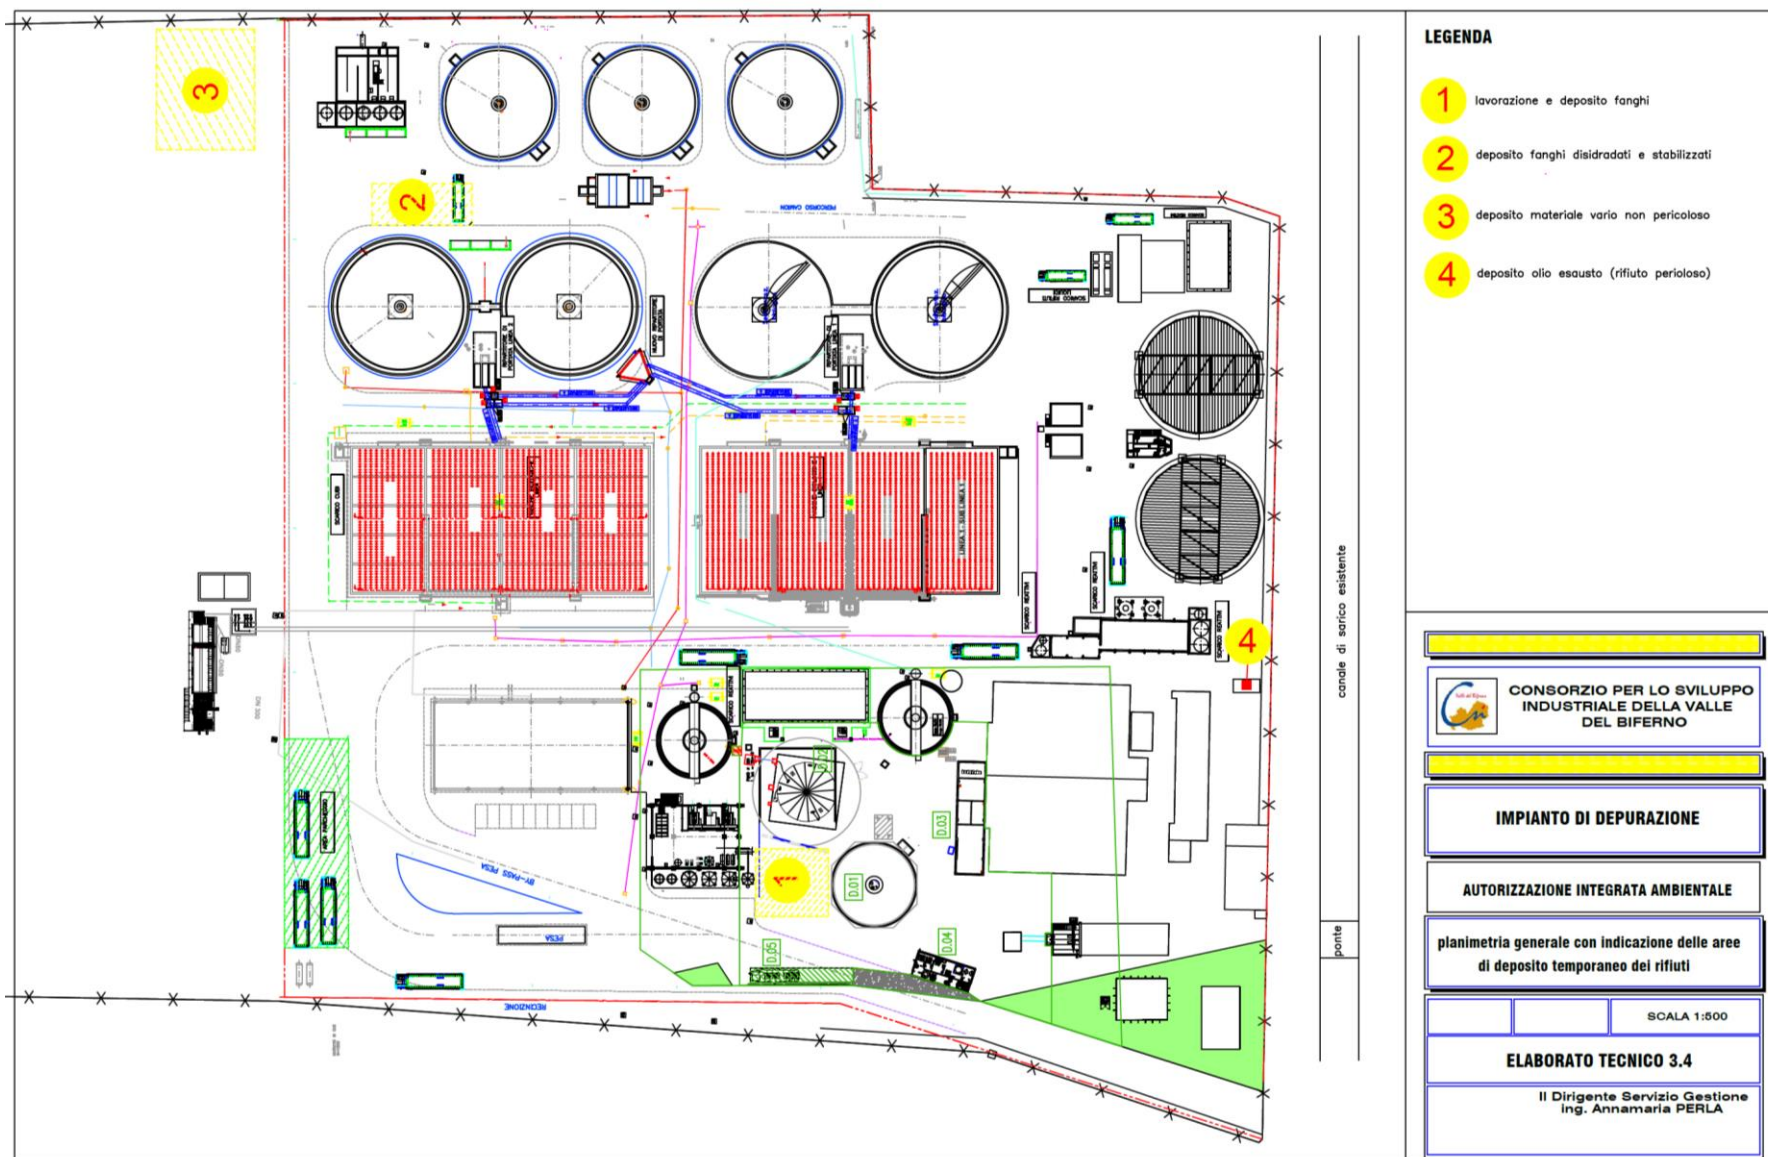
planimetria generale di stabilimento con indicazione delle aree dedicate al deposito temporaneo di rifiuti
